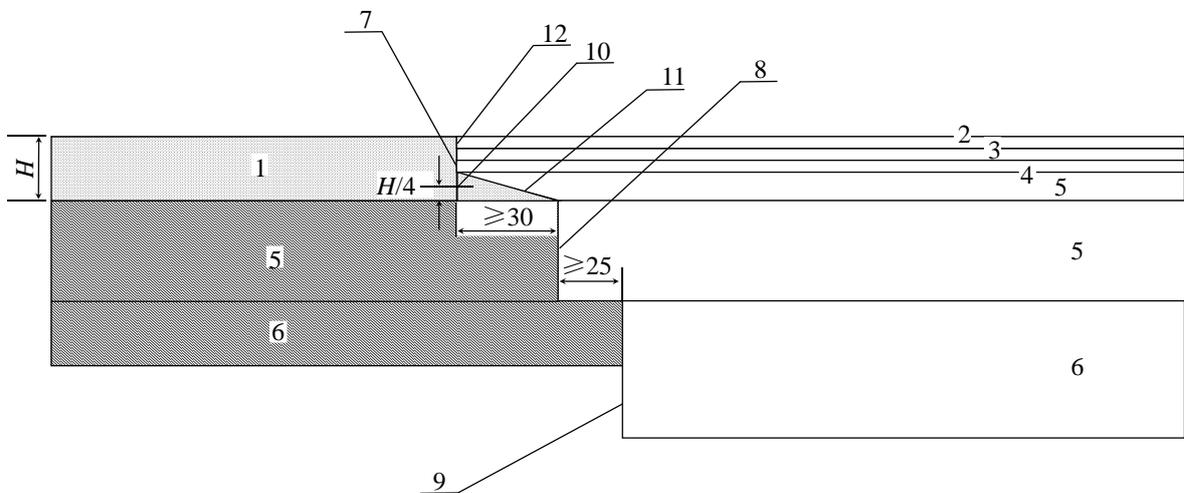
水泥混凝土路面结构拼接沥青混凝土路面结构典型拼接构造图（尺寸单位：cm）
